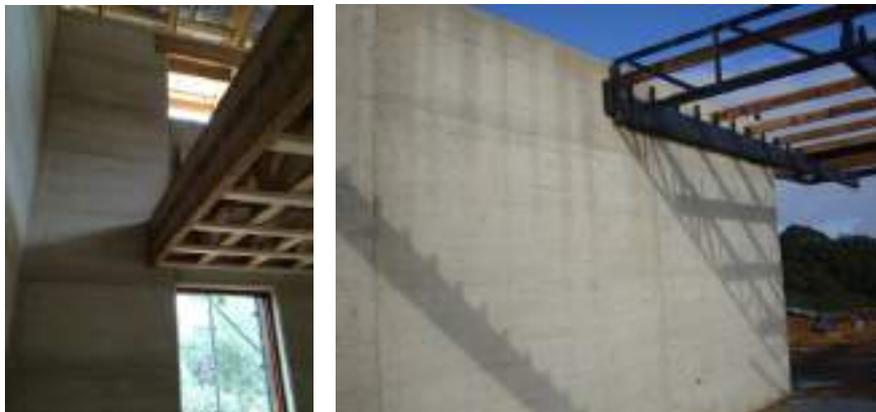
Exemplos de conexões de piso em madeira e viga metálica para cobertura, 2014 (Créditos: Oliver Petrovic)
